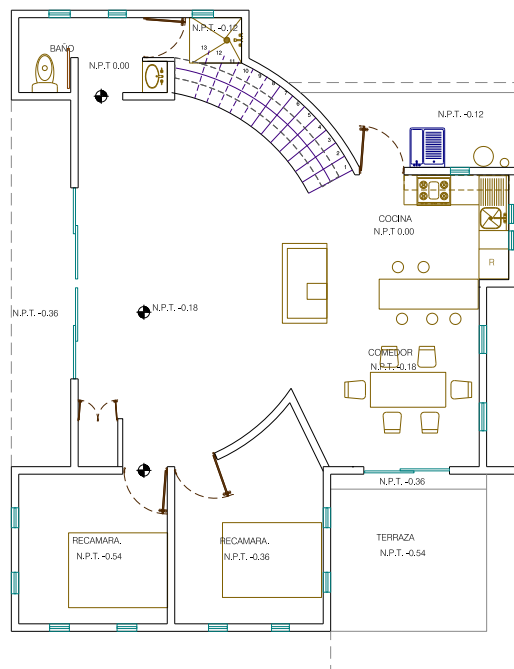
Distribución Arquitectónica de la Planta Baja
